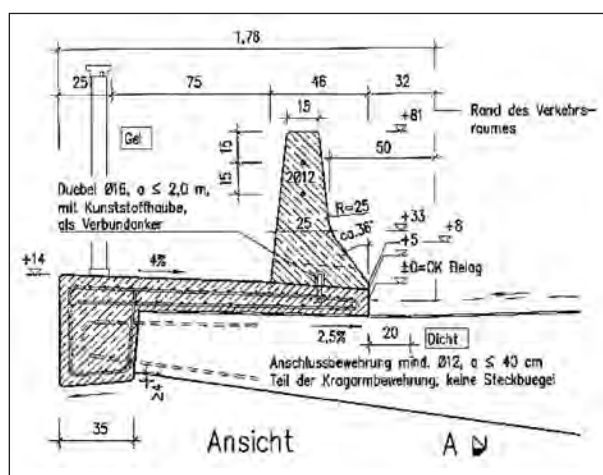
Richtzeichnung Kap 11: einseitige Betonschutzwand in Ortbetonbauweise auf Brücken
